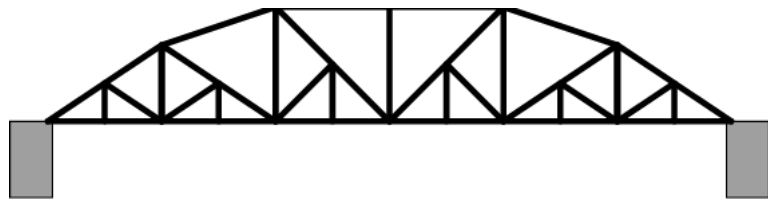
Armadura tipo Pennsylvania o Petit.
